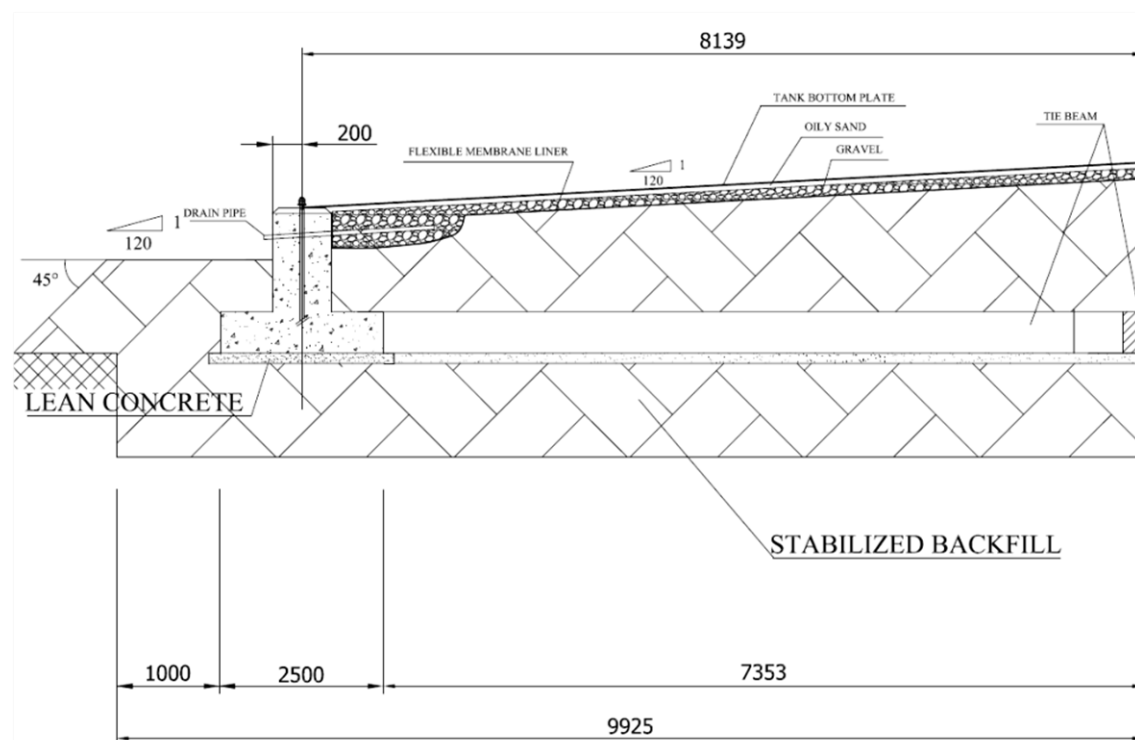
Sezione verticale della fondazione del serbatoio fino a mezzeria
